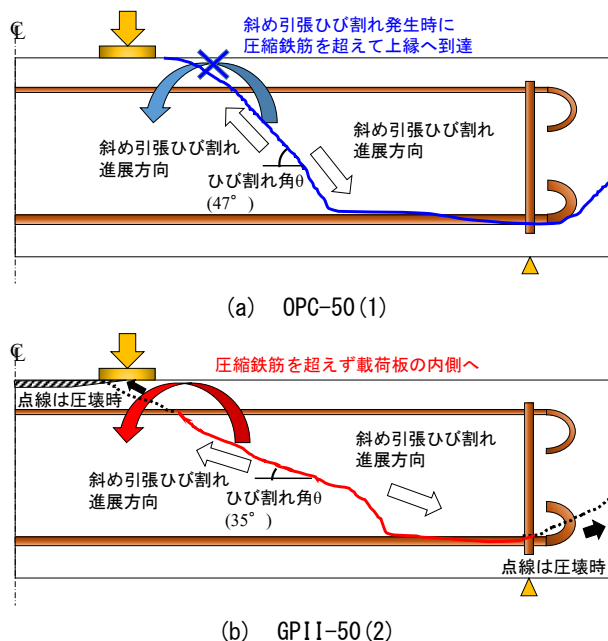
斜め引張りひび割れ発生後の進展状況
